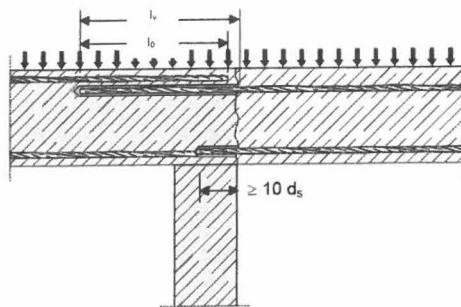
Überlappingsverbindung bei der Verankerung von Bewehrungsstäben in Platten oder Balken.
